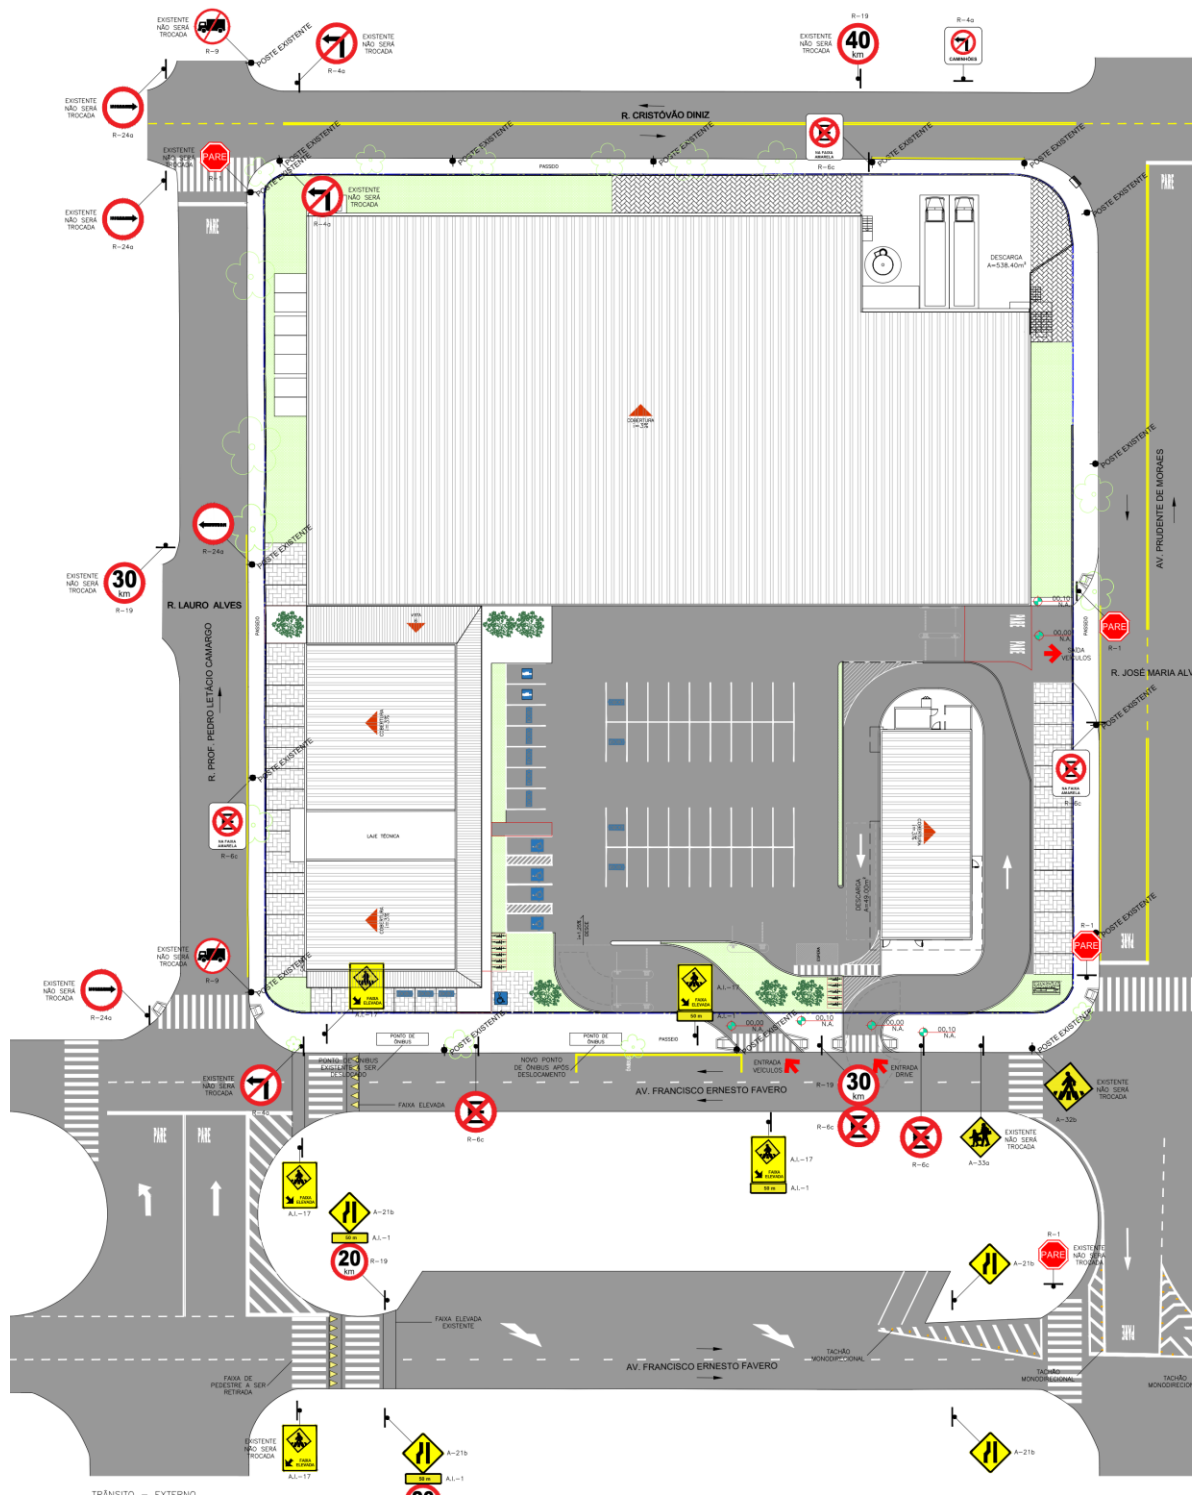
Projeto de implantação do empreendimento: Primeiro Pavimento.
